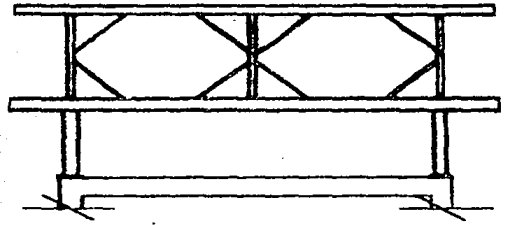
ESTRUCTURACION DE MARCOS LONGITUDINALES
